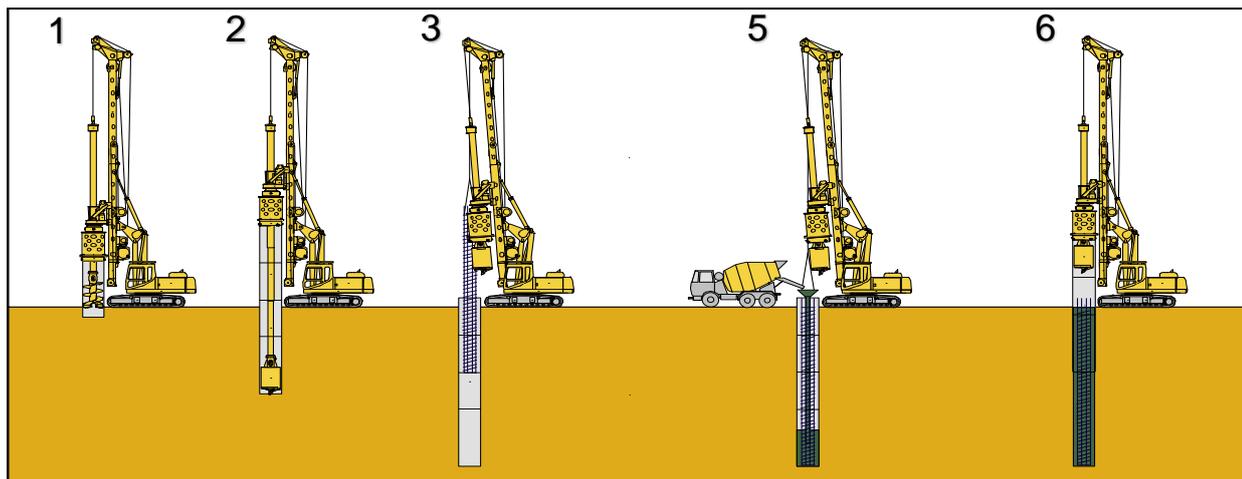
Буриабивные сваи под обсадной трубой с келли-штангой.
